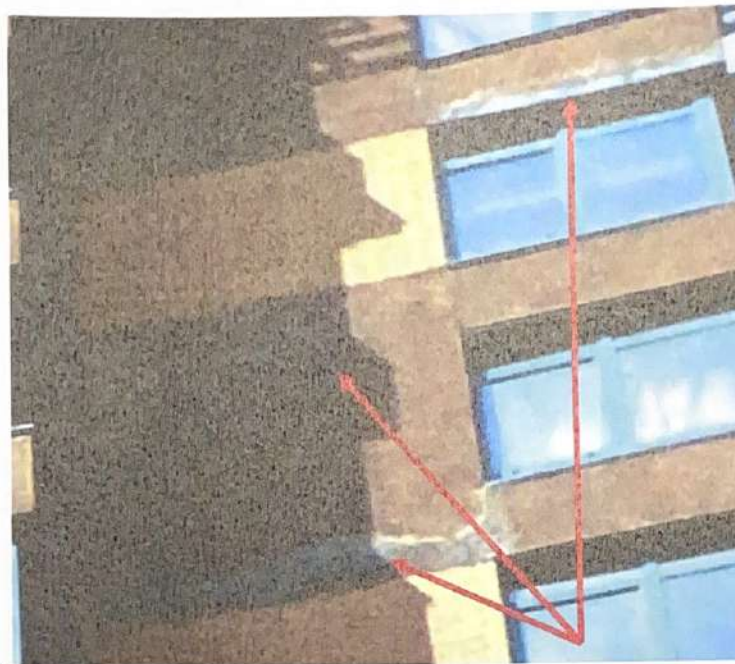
Фасад по оси F1. Разрушения фасада. Повреждения по часткам восстановительных работ.
